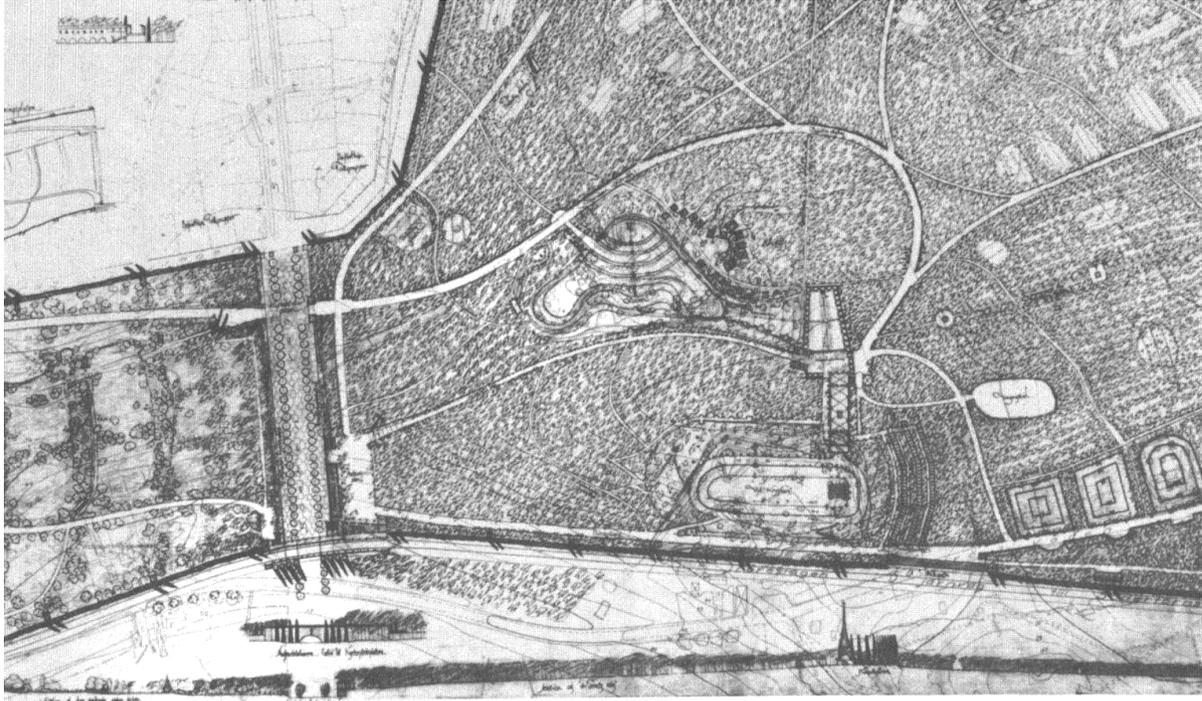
1.1.13 Plano cementerio Woodland en Estocolmo
